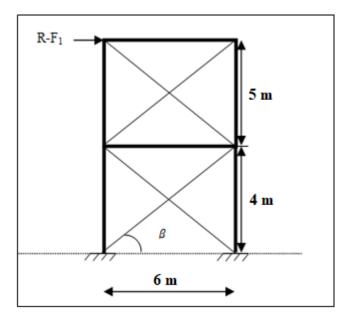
Schéma statiquedePaléedestabilitéen longpan
